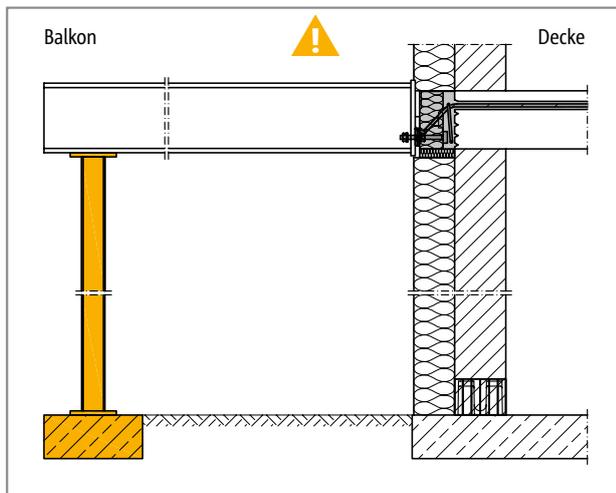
Schöck Isokorb® RT Typ SQP: Stützung durchgängig erforderlich
